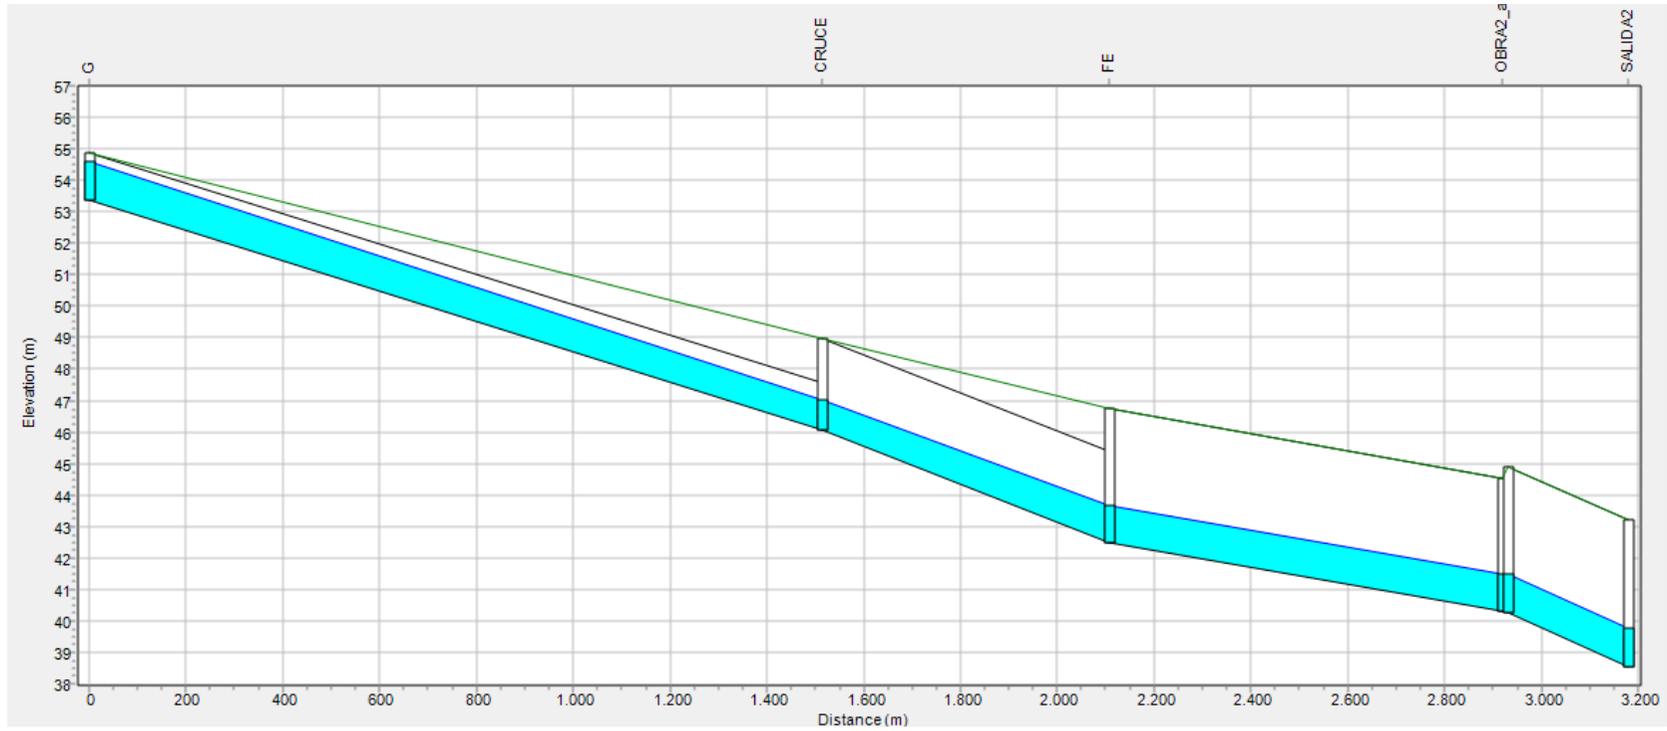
Perfil longitudinal A° N°10438 - escenario con obras en caudal máximo
